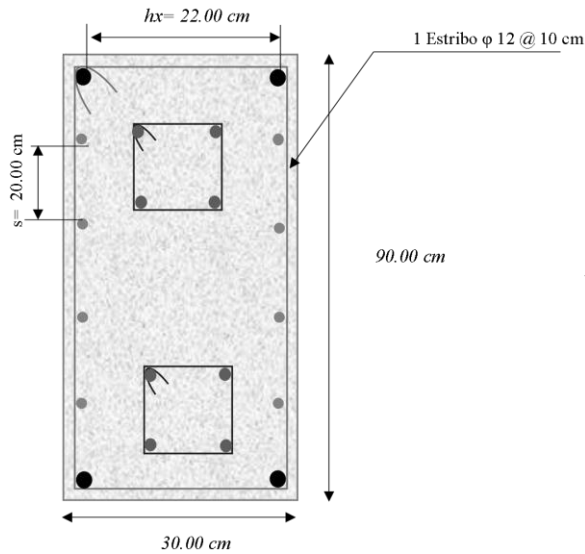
Armado de las vigas de acople de la geometría 3 en base al FBD
